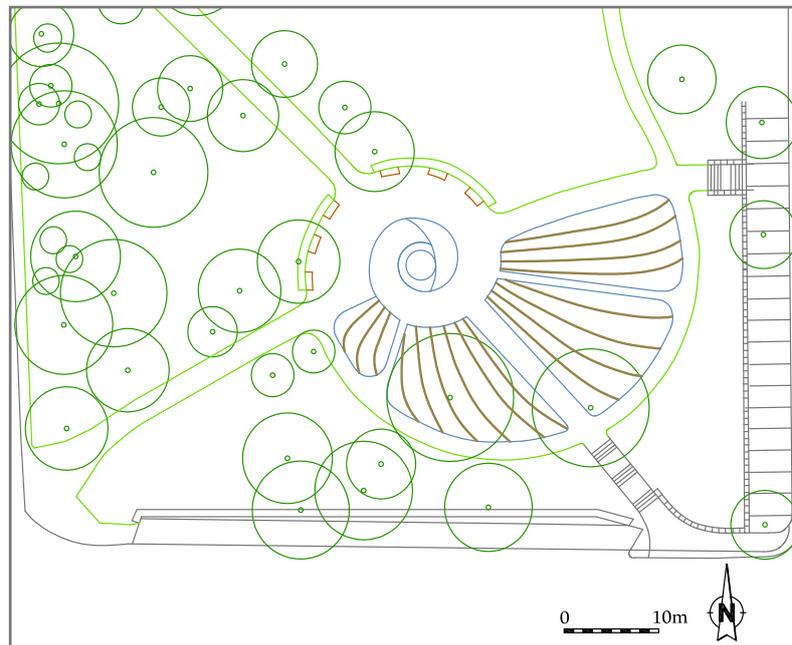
Entwurf Bepflanzungsplan (Plangrundlage: Schwarze und Partner 2009)
